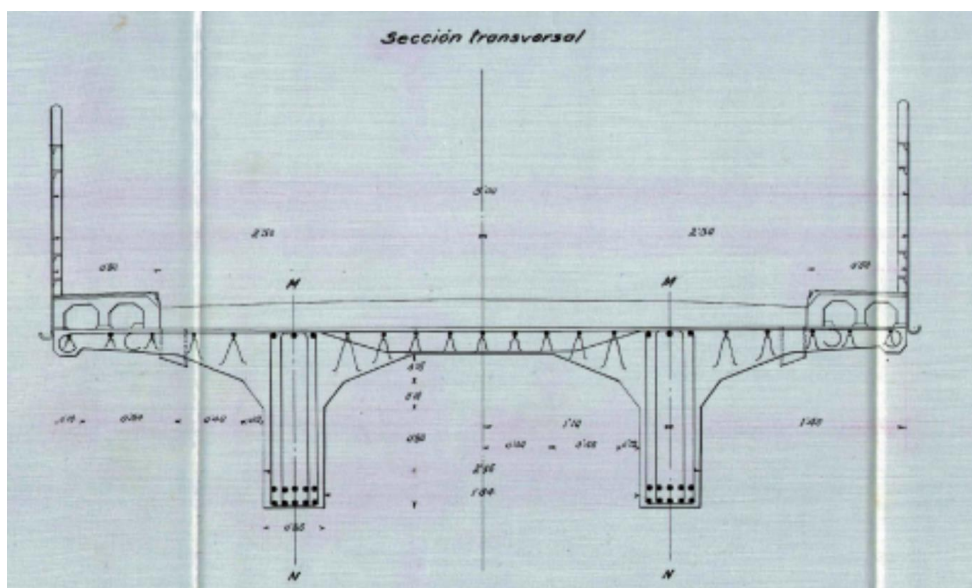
Sección transversal del tablero del puente sobre el río Anoia (Planos del proyecto de reforma , 1928)
